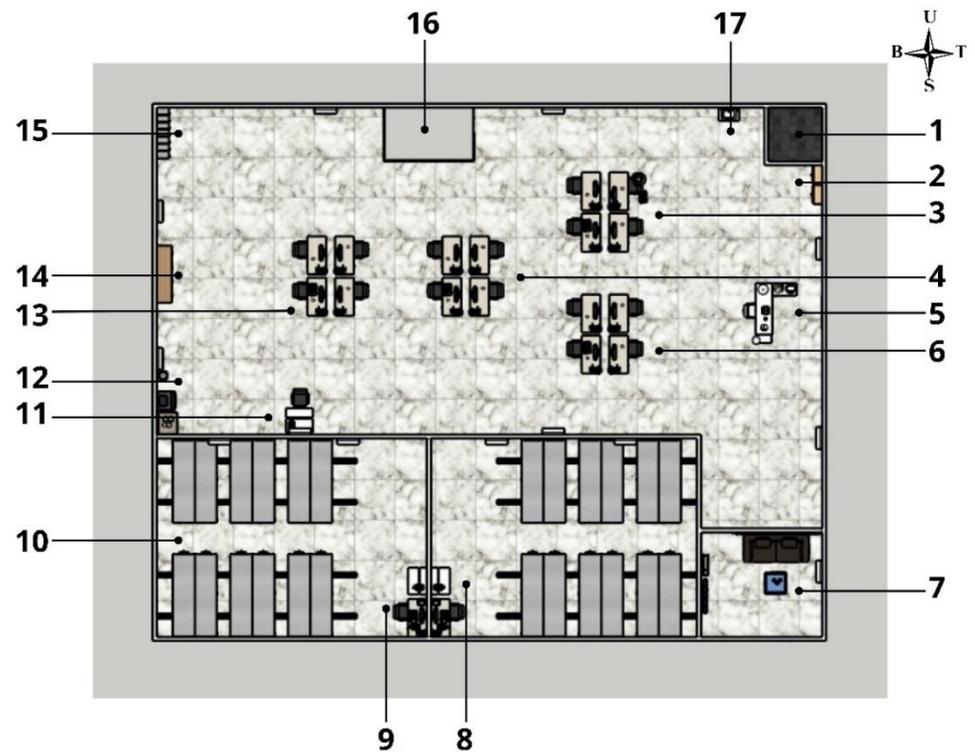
Denah Lantai Kasar untuk Ruang Rekam Medis
